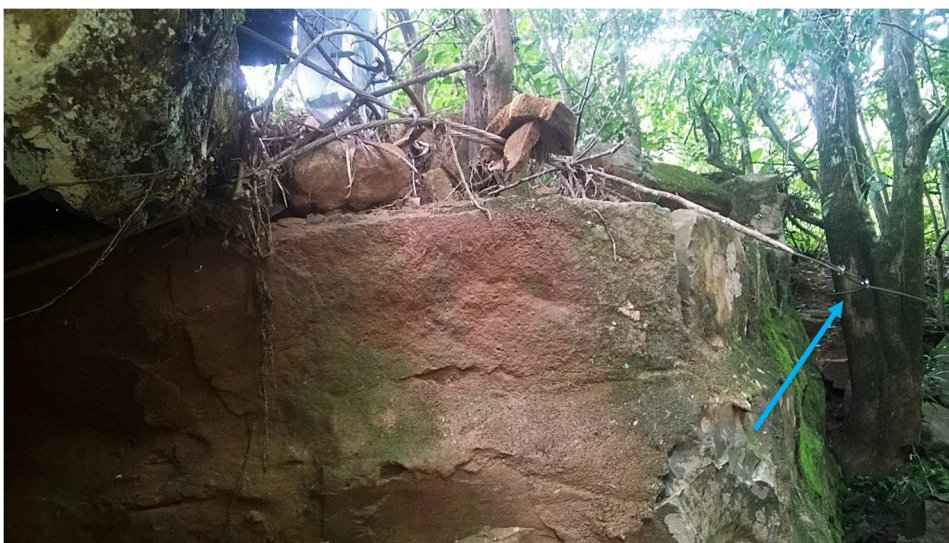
Rachadura estrutural séria, ruptura por fendilhamento (Viga C - Lado sul)
